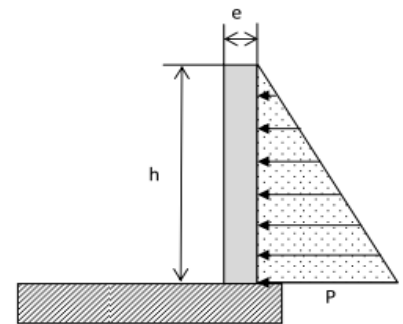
Poussées des terres sur les Voiles périphériques
